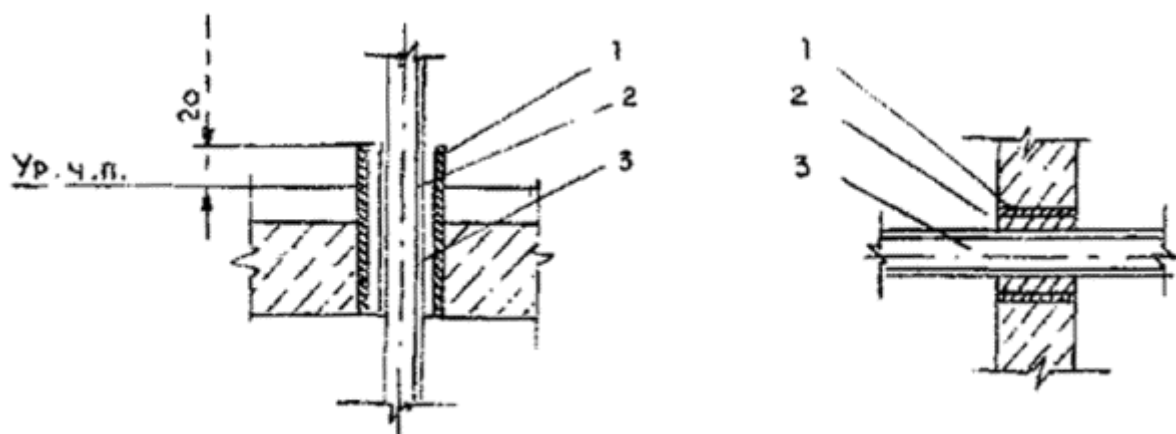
Установка гильзы для прокладки труб в стенах и перекрытиях:
